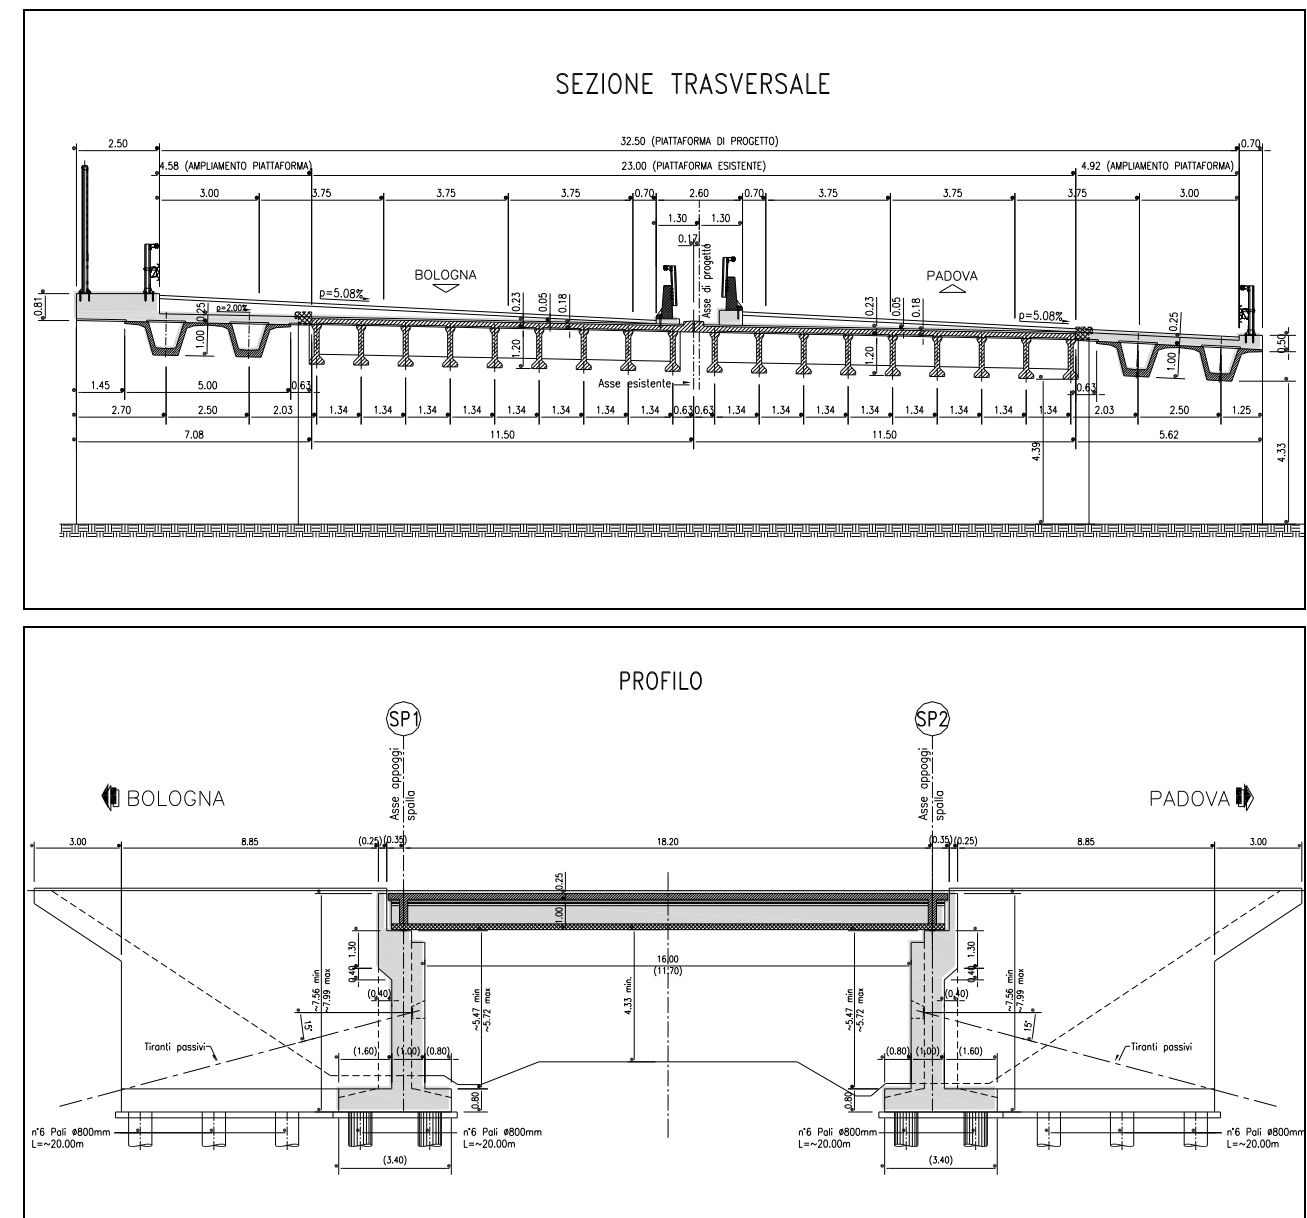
Sezione dell'impalcato e profilo del sottovia della SP 14
